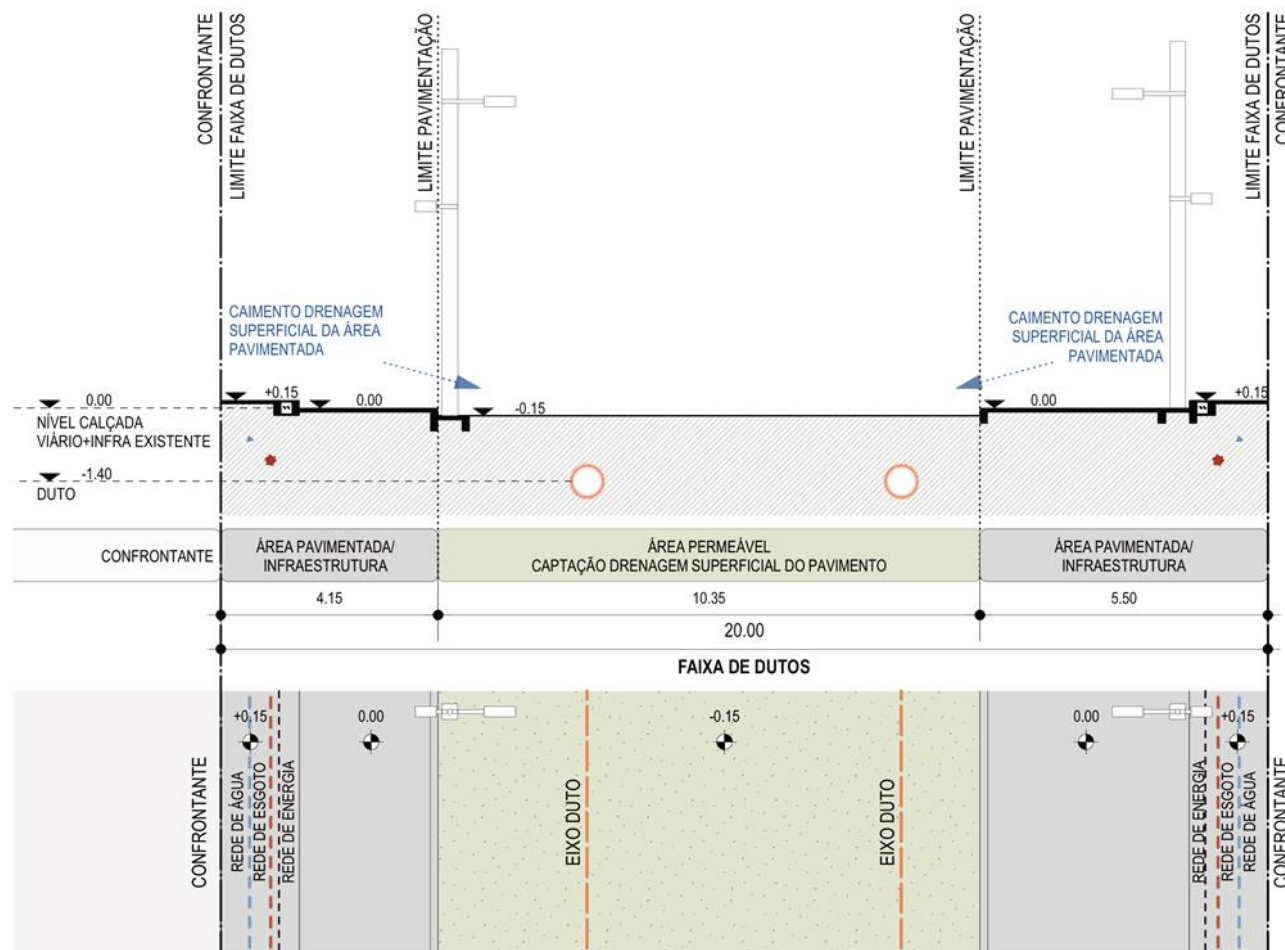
Seção típica proposta para a faixa de dutos. Organização das linhas de infraestrutura e e esquema geral de pavimentação e drenagem. Elaboração própria.
